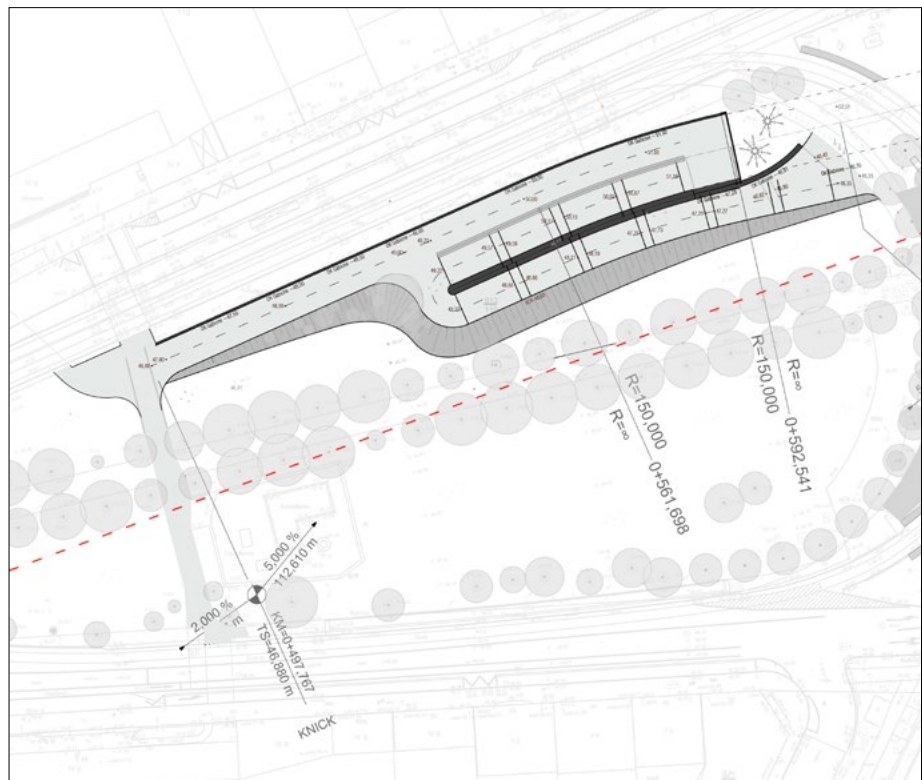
Grundriss linksrheinische Rampe
